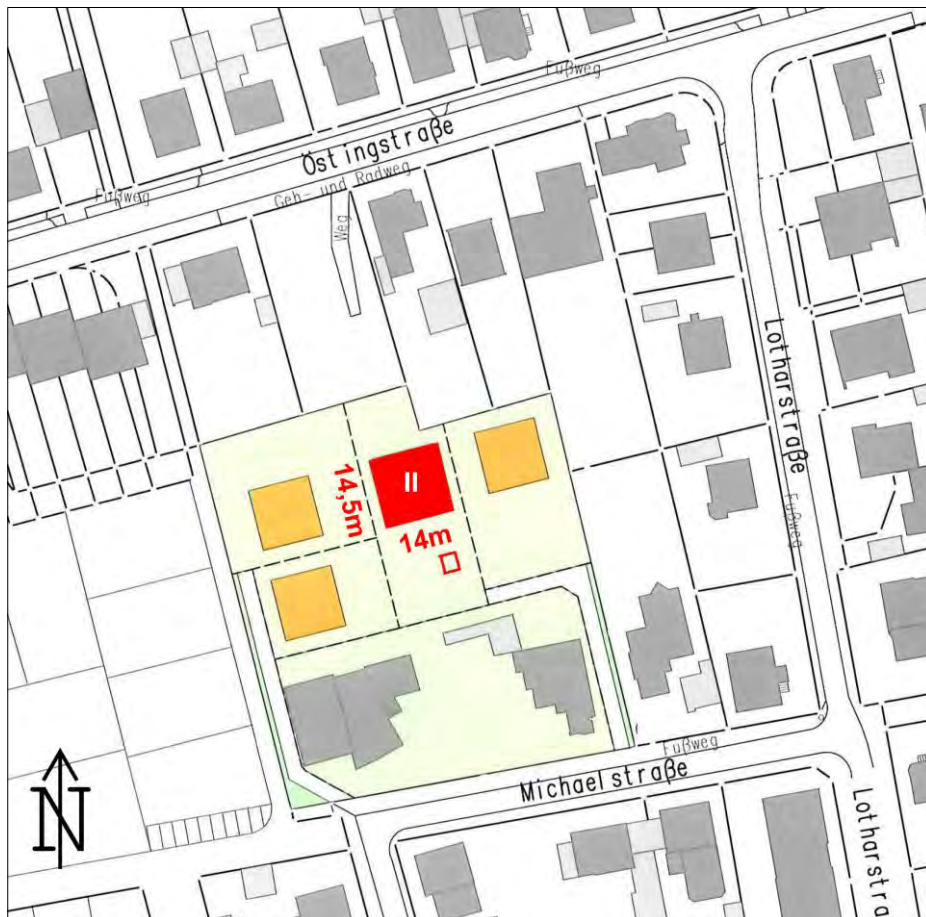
Lageplan Grundstücke mit Baufeld (ohne Maßstab)
